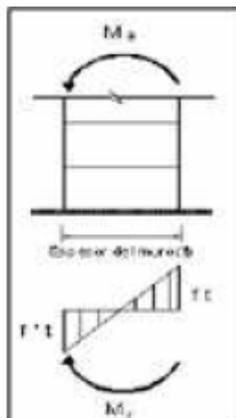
Momento resistente M_r en un muro de albañilería
